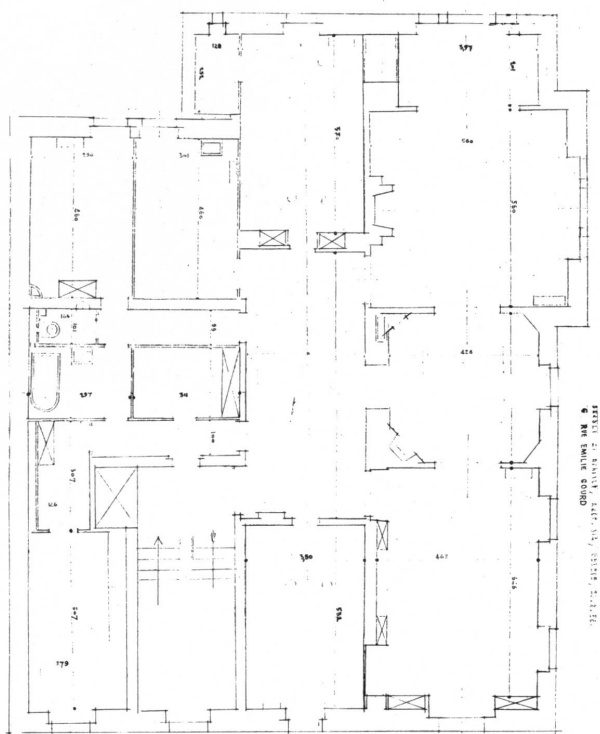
Rue Emilie-Gourd n° 6. Plan d'un étage courant.
